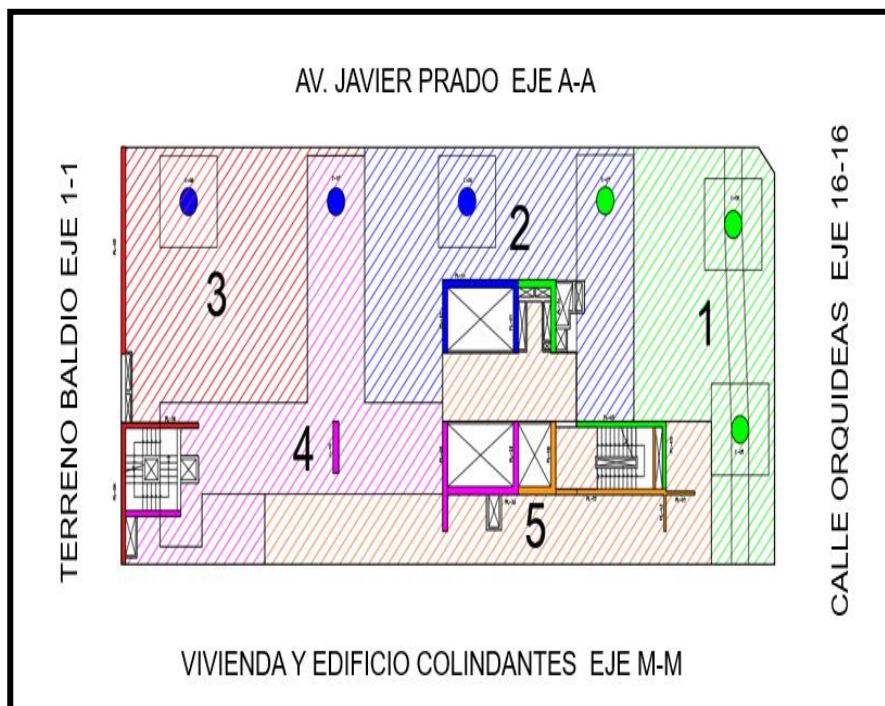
Vista en Planta de la Sectorización de Pisos Superiores 20 al 27
